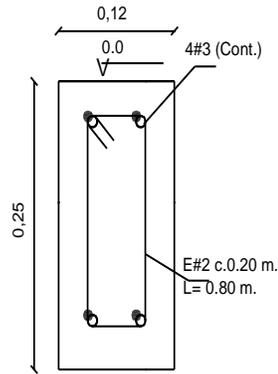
REFUERZO HORIZONTAL Y MUROS SEGUNDO PISO
